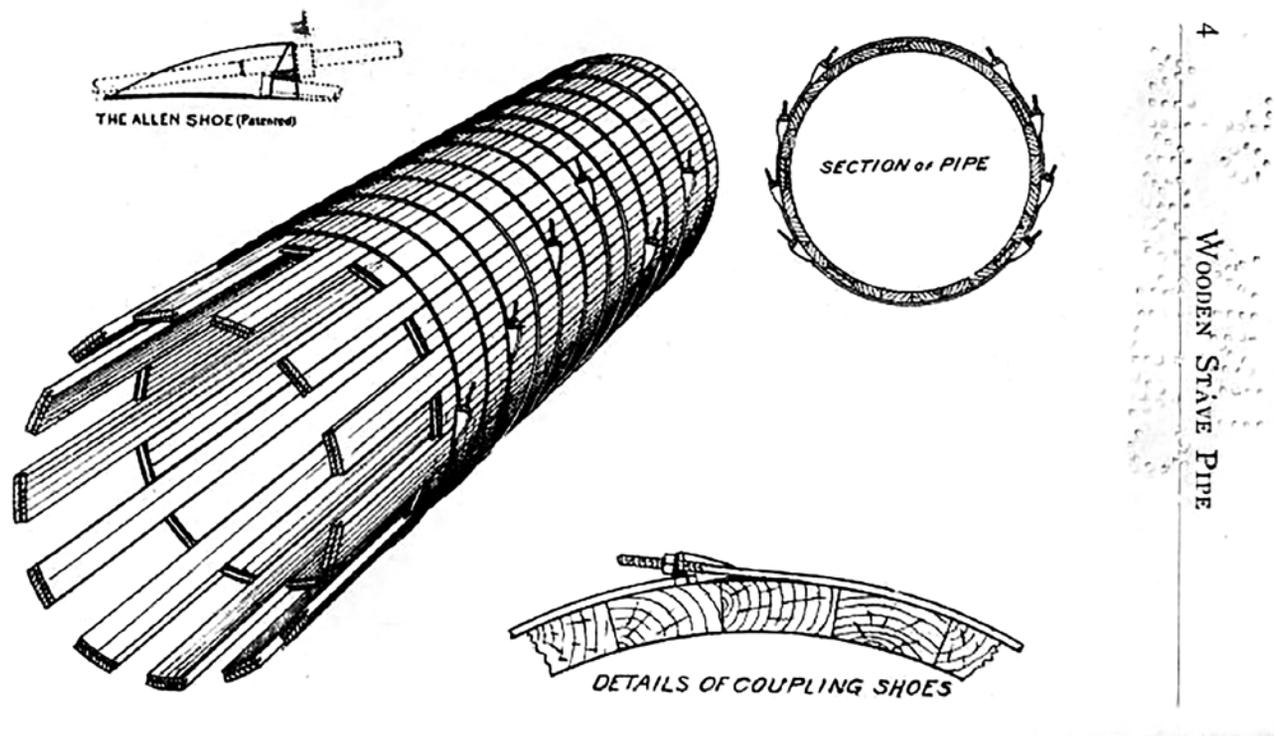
Plano de una stave pipe (tubo de duela). © Redwood Manufactures Company.
